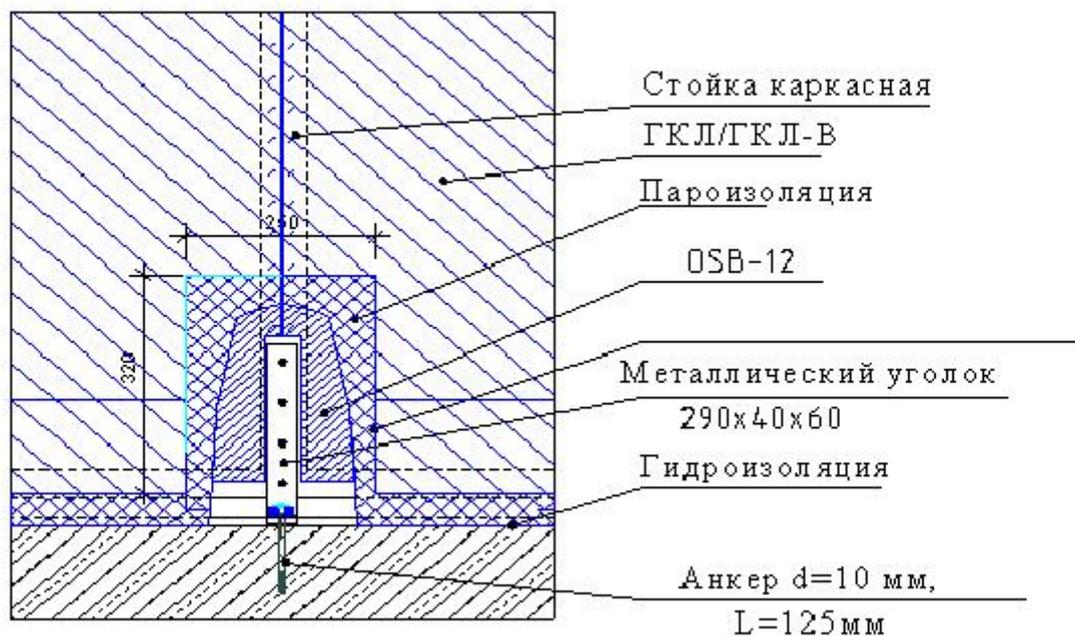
Узел крепления наружной стеновой панели и перекрытия на отметке 0.000
